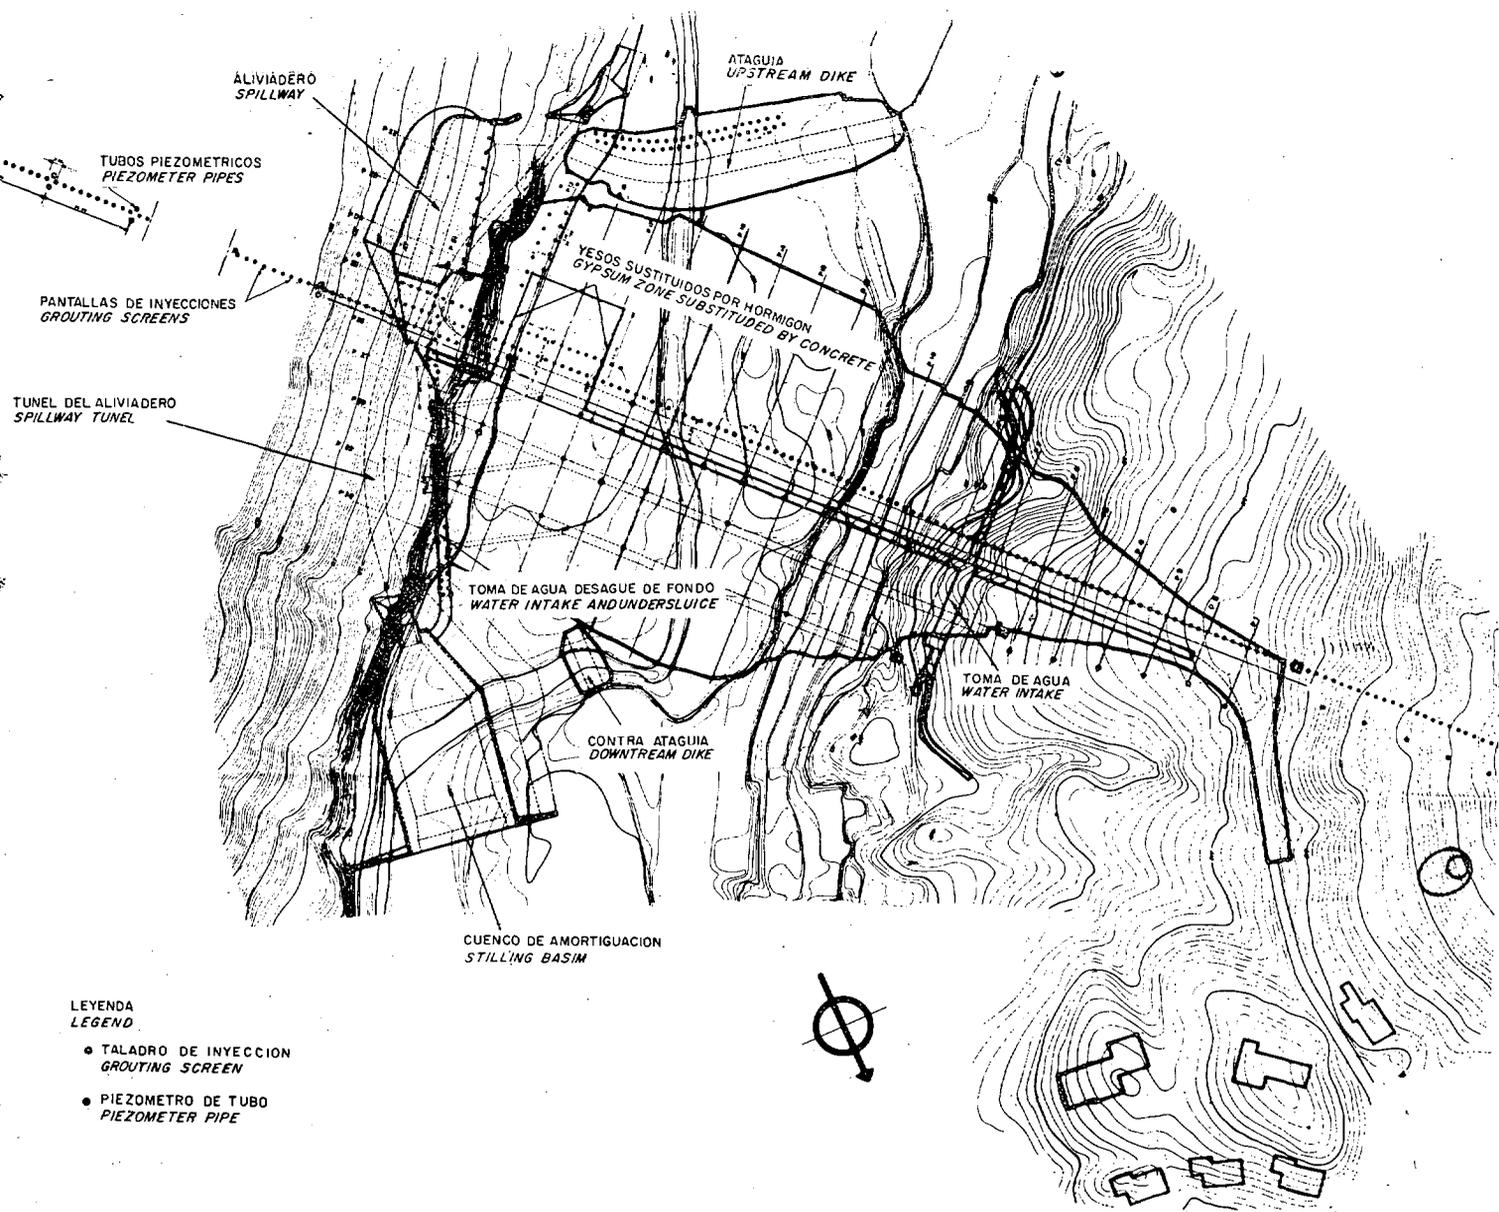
ª — Planta de la presa. (Plan view of the dam).
